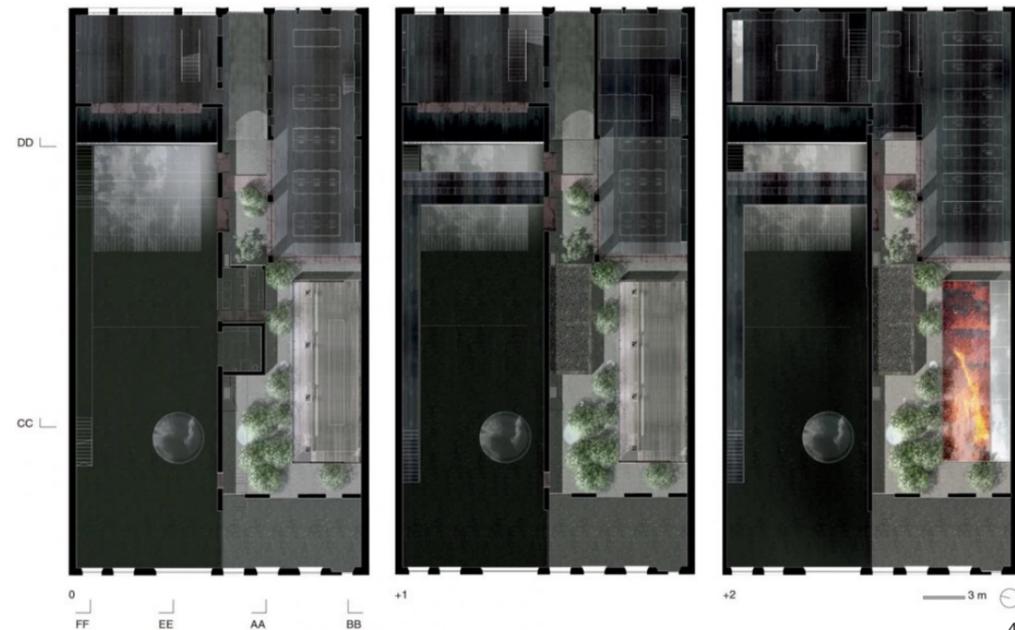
Planta baja, primera y segunda del Espacio Barberí.
